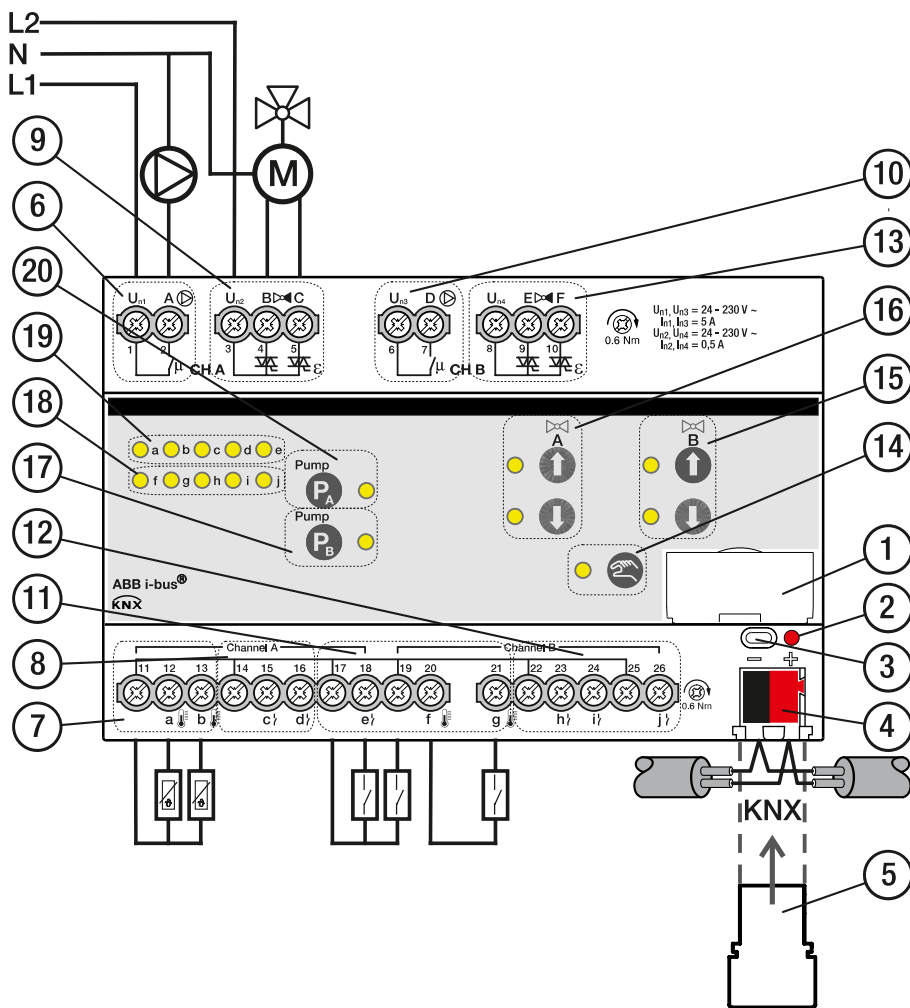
Schema di collegamento HCC/S 2.2.2.1
